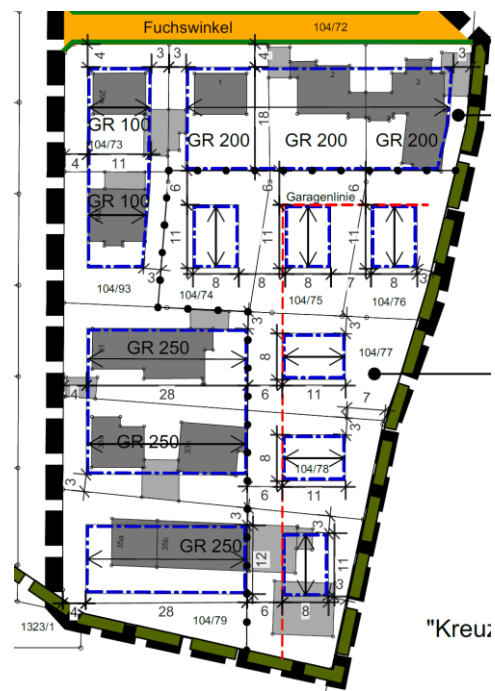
Bebauungsplanvariante 2 - Nachverdichtung der rückwärtigen Bereiche
